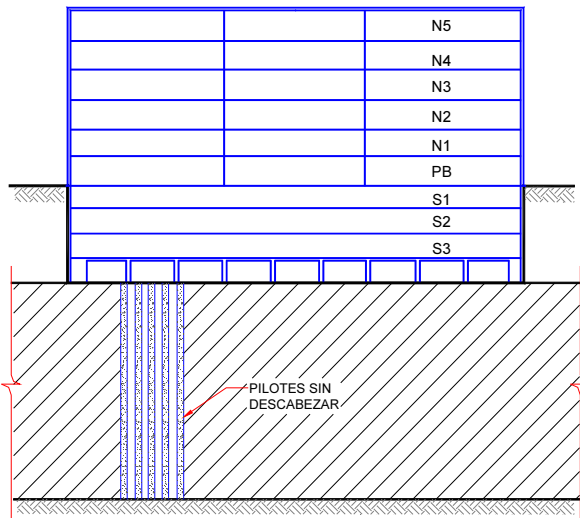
Corte longitudinal del Edificio con Vista de los pilotes sin descabezar
